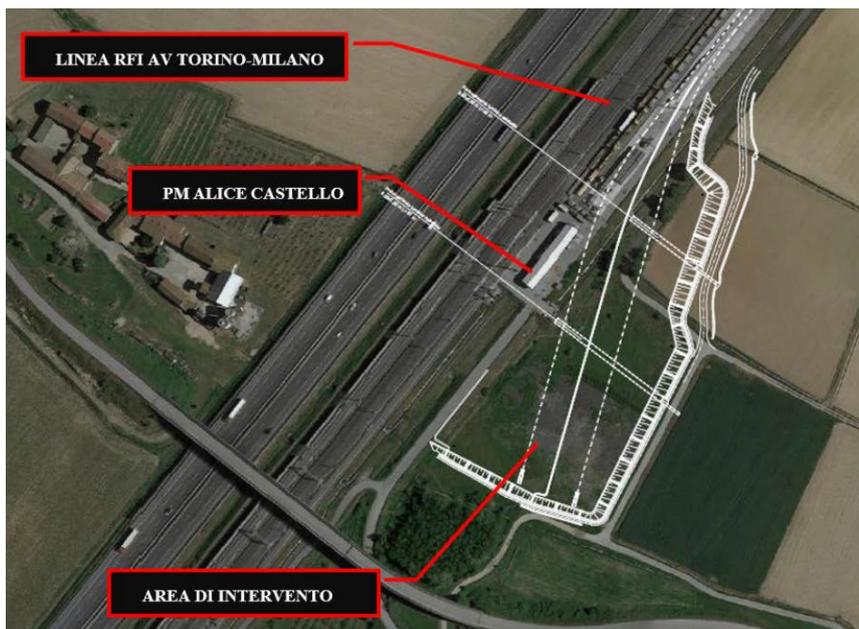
Planimetria di progetto su ortofoto, in bianco gli interventi oggetto di valutazione preliminare (Fonte: Lista di controllo)
